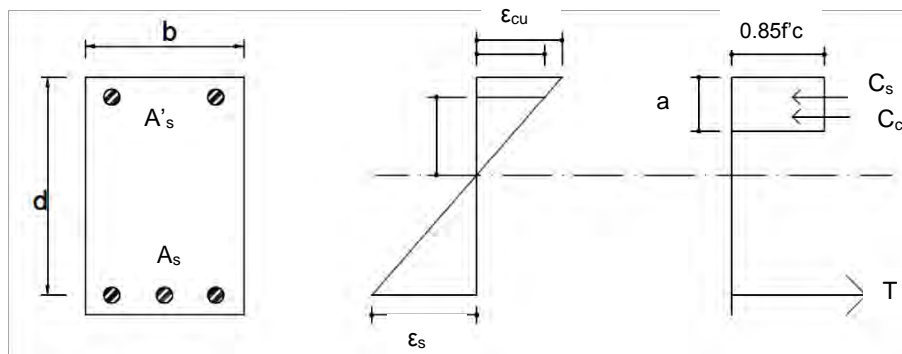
Secciones rectangulares doblemente armadas (adaptado de González y Robles 2005)
